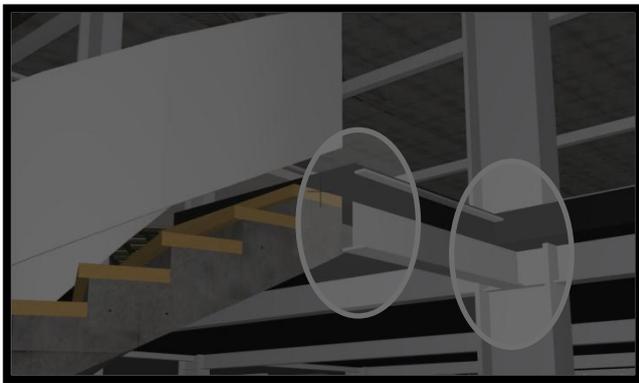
Détails d'assemblage poteaux poutre escalier dalle
